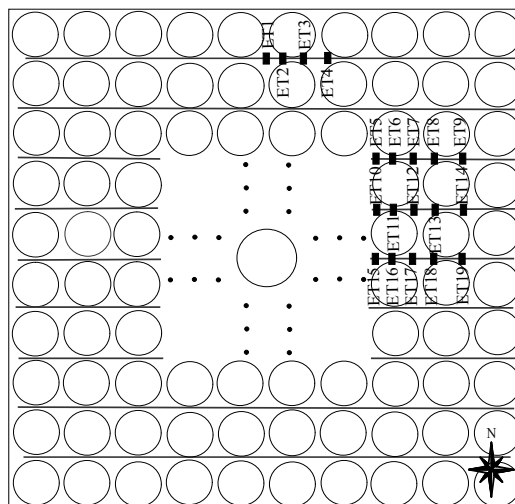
Localização dos extensômetros nas treliças da laje BD-A02
